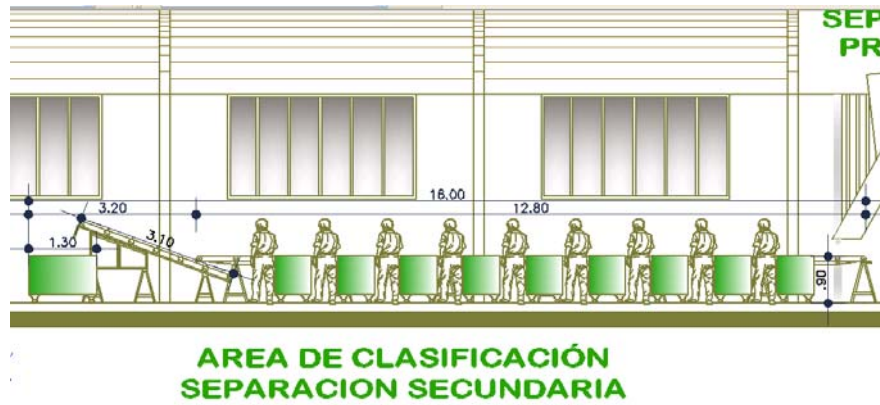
Proceso de separación secundaria de la planta de reciclaje
